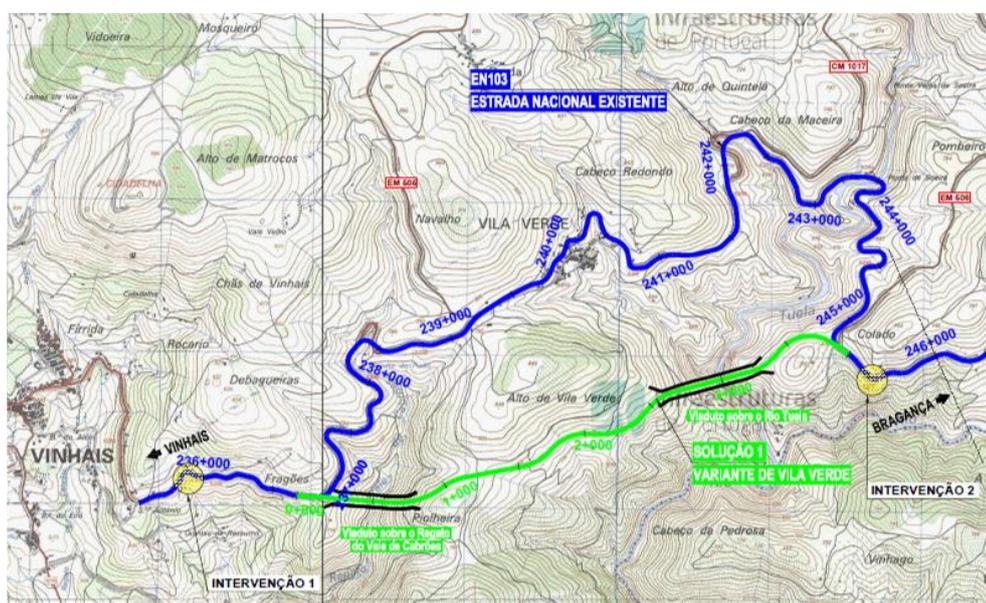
Implantação da Variante de Vila Verde – Solução 1
